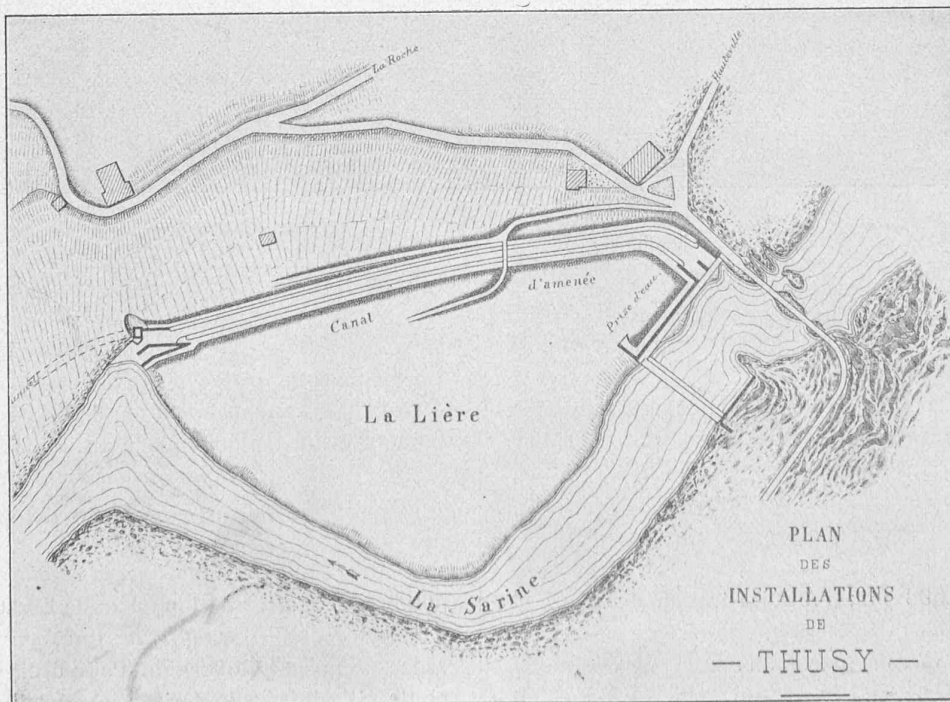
Plan de situation du barrage et du canal d'amenée. — Echelle: 1 : 4250.
